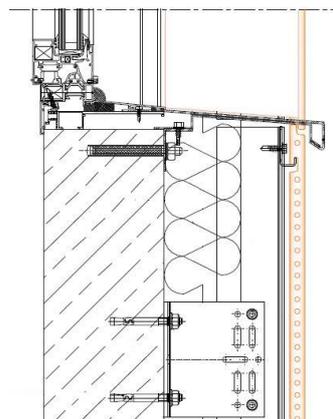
Alféizar. FAVEKER® FV. Sistema clip.
